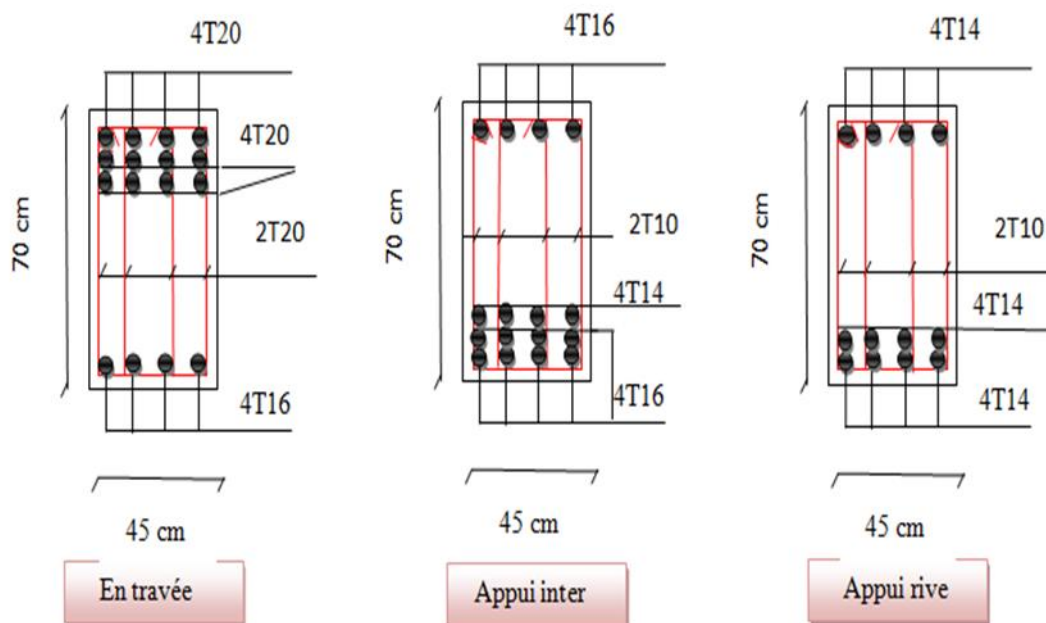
Ferrailage de la poutre de libage suivant le sens longitudinale.
